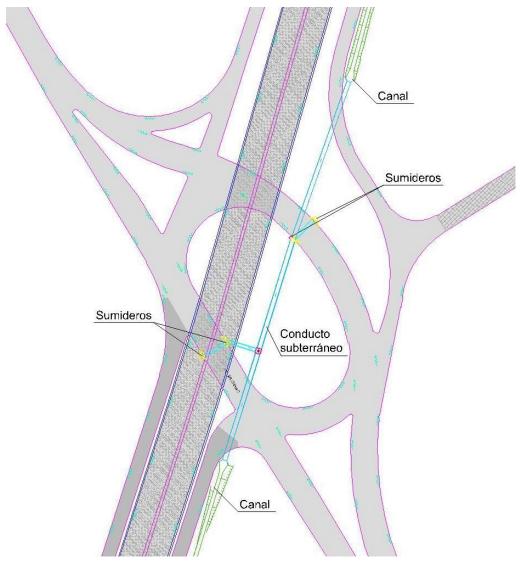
Reperfilado de canal existente y canalización del escurrimiento en la intersección de Av. Lugones Norte y Av. Belgrano.
